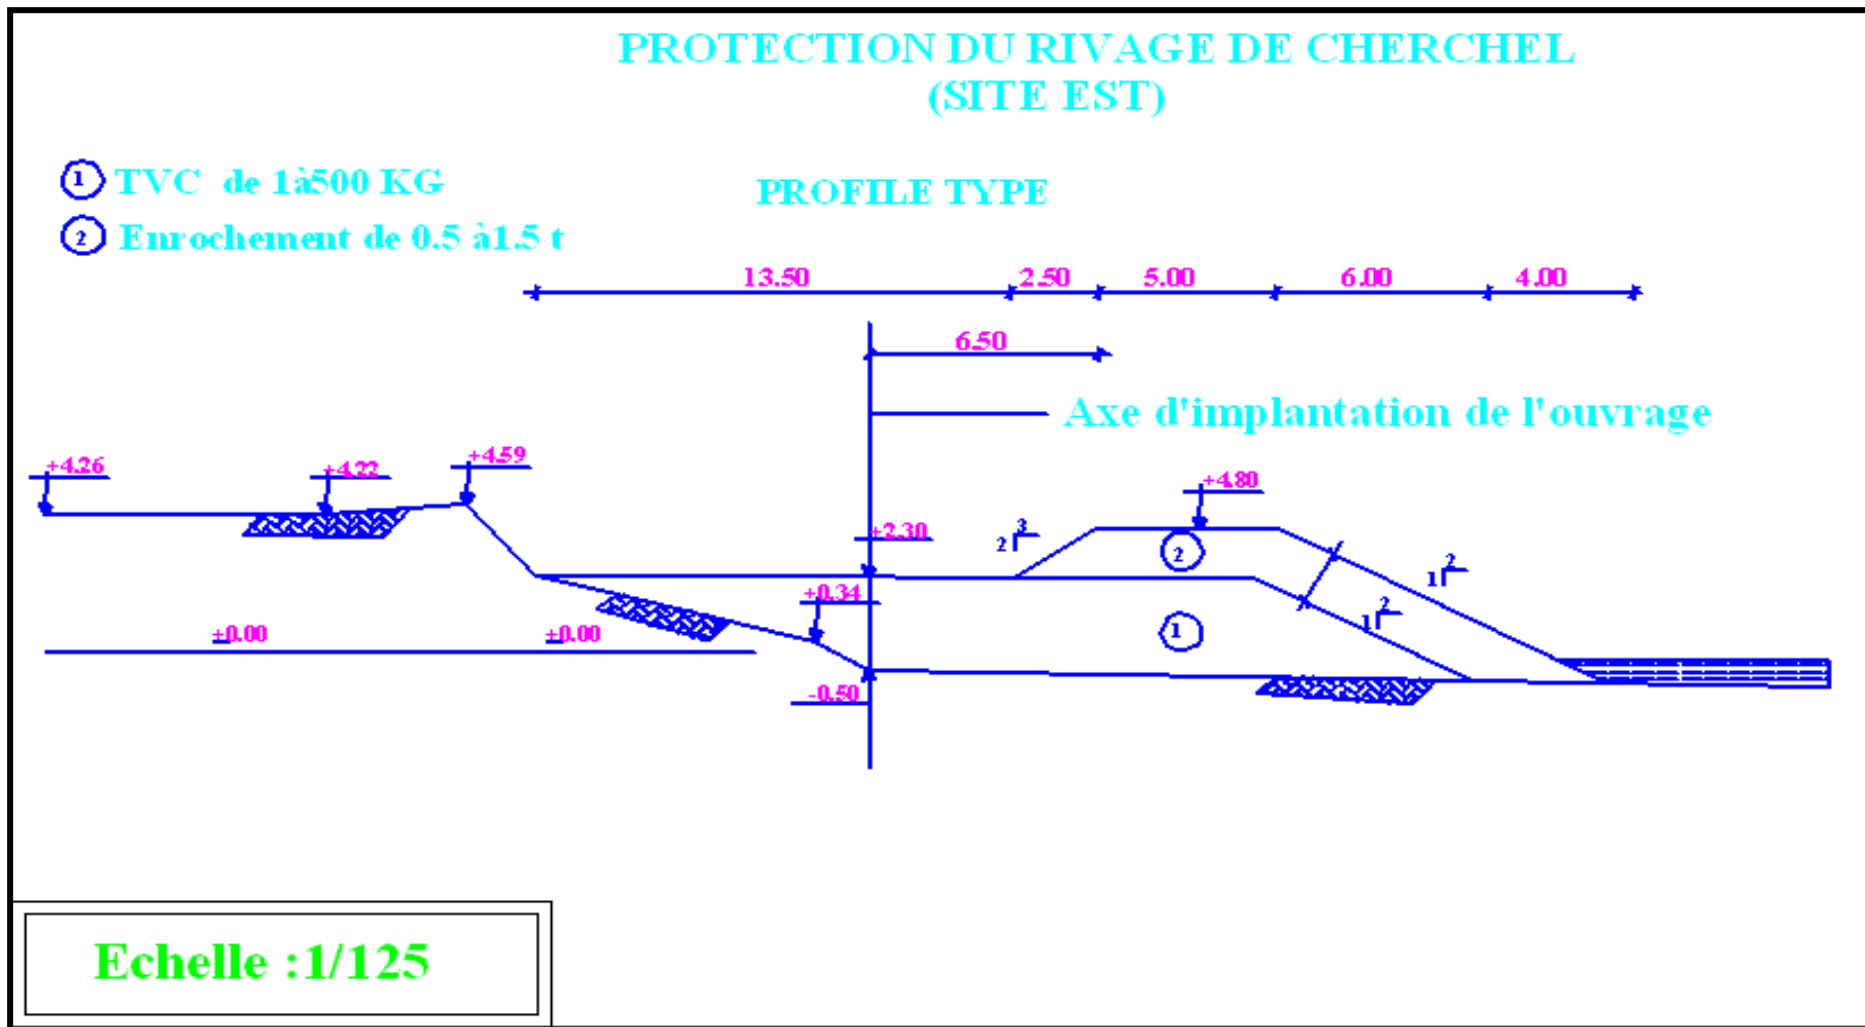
Le profil type de la protection du site Est (DTP de la wilaya de Tipaza, 2004)
